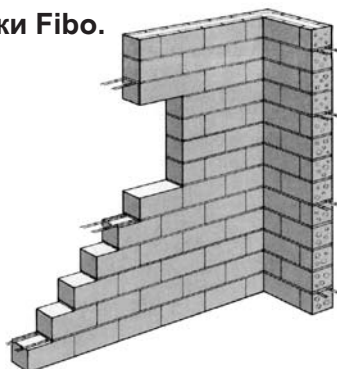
Армирование кладки Fibo. Правильное использование Vi-арматуры Fibo.
